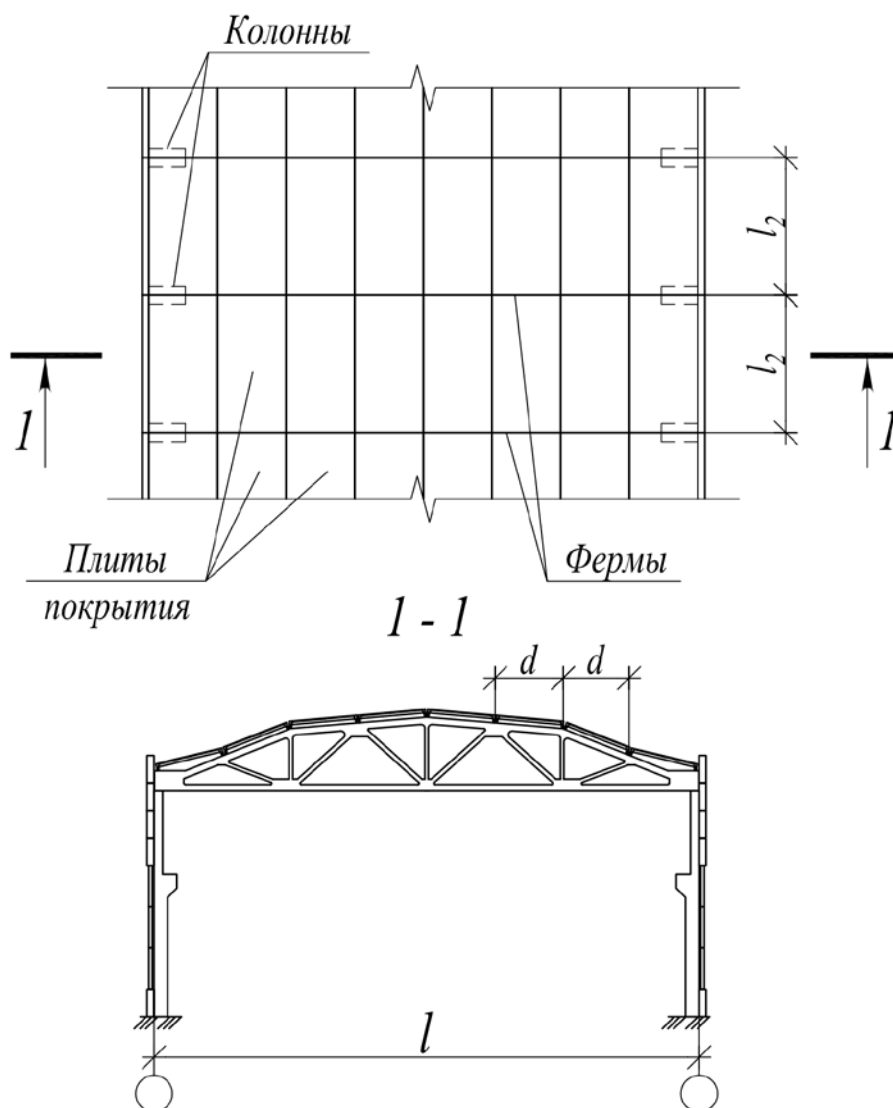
Фрагмент схемы покрытия одноэтажного промышленного здания
